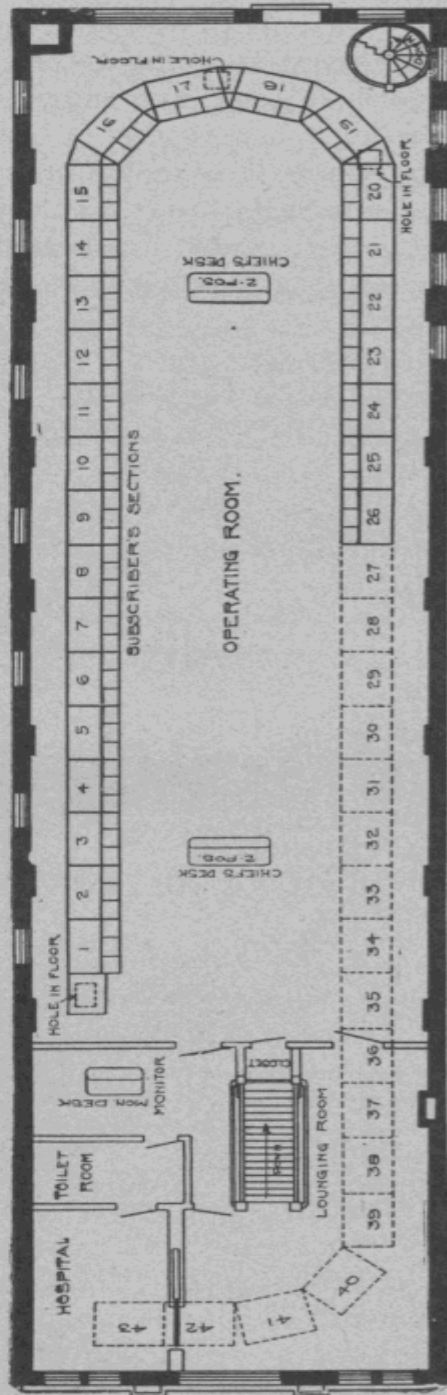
Plan de la salle du multiple du bureau central de Los Angeles.
